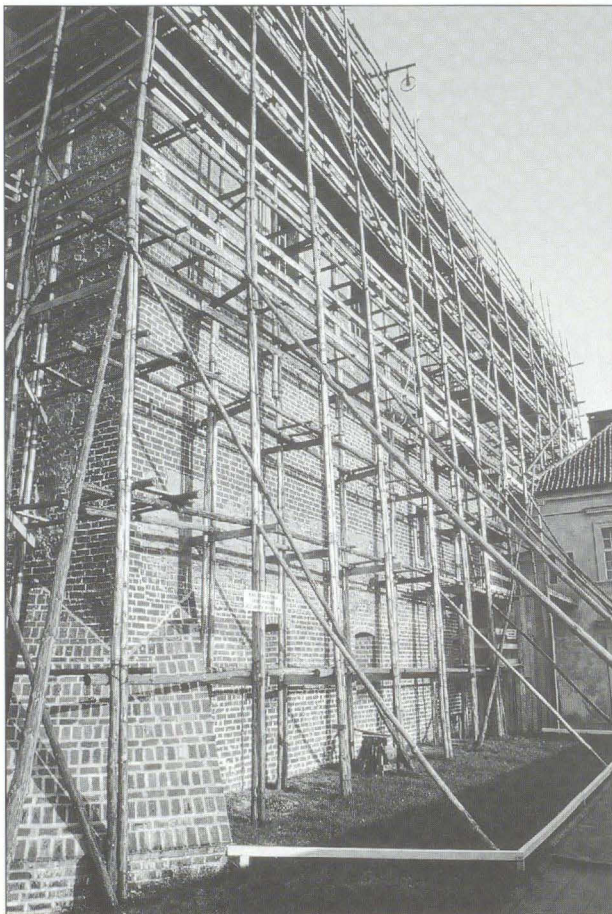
Schloß Gollub, Westpreußen. Doppeltes Stangengerüst mit Abstreben.
